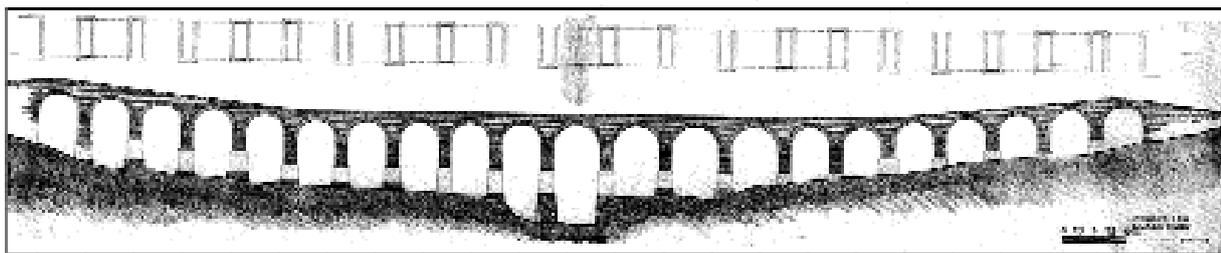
Ponte Aurunco a Suessa, prospetto (T. Rocco e L. Emanato).
